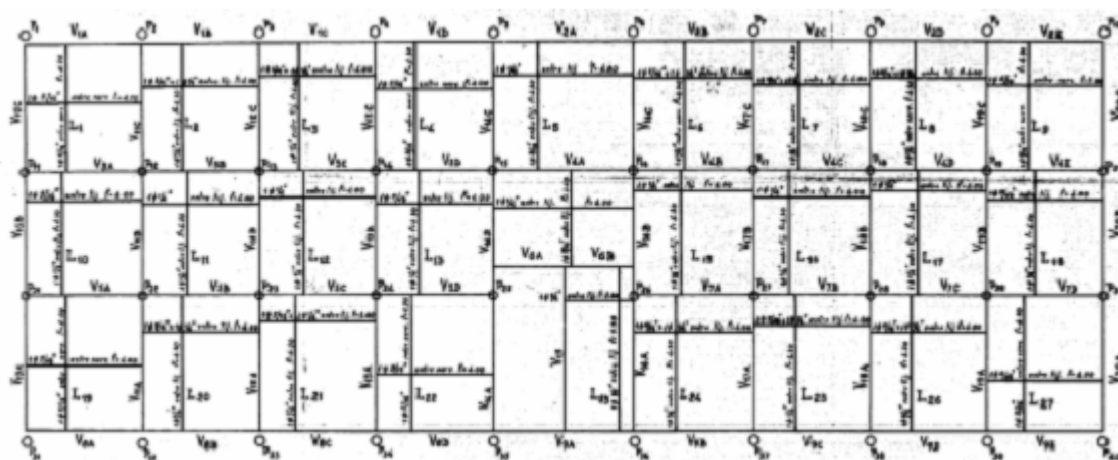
Planta estrutural do tecto da cave do edifício Costa Cabral (adaptado de Milheiro, 2008)
